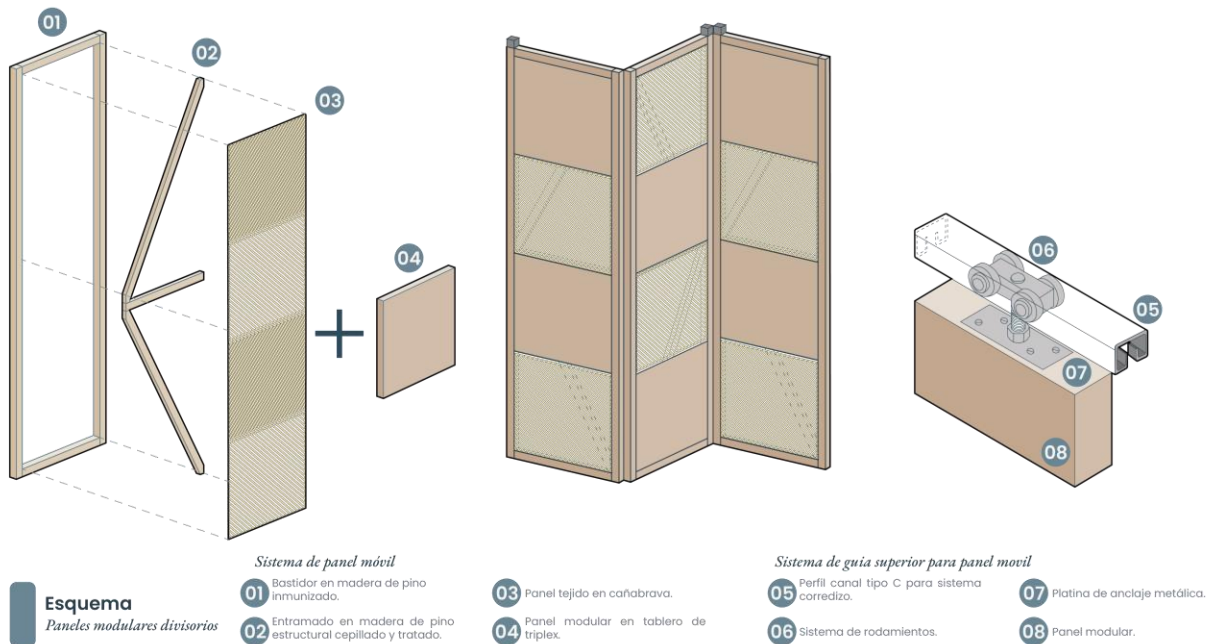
Configuración paneles móviles. Elaboración propia.
